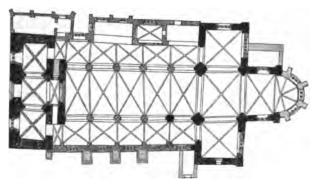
Bergen. Marienkirche. Grundriss. 1:667.
